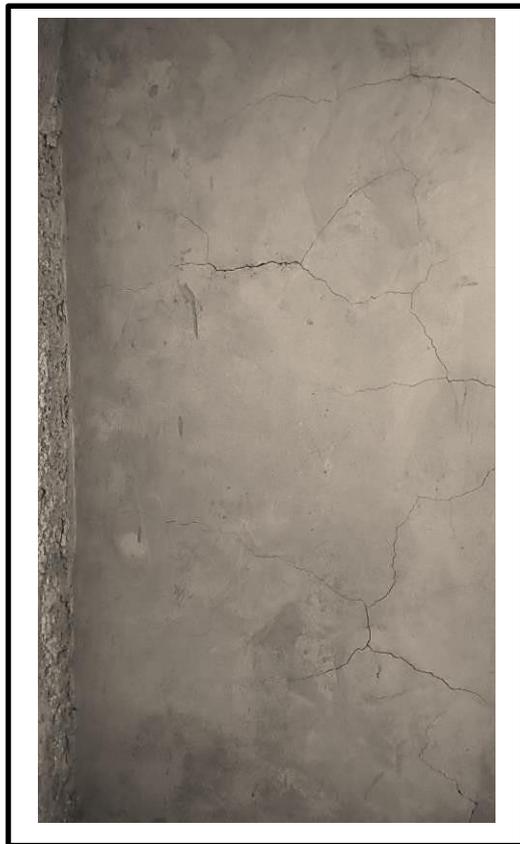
fisuras en toda el muro de la Urb. Santa María del Pinar
